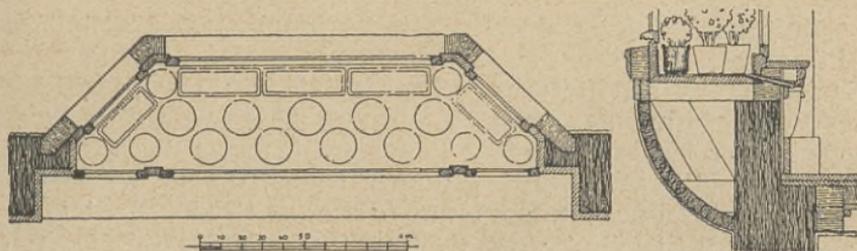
und 99. Blumenfenster. Grundriß und Schnitt
